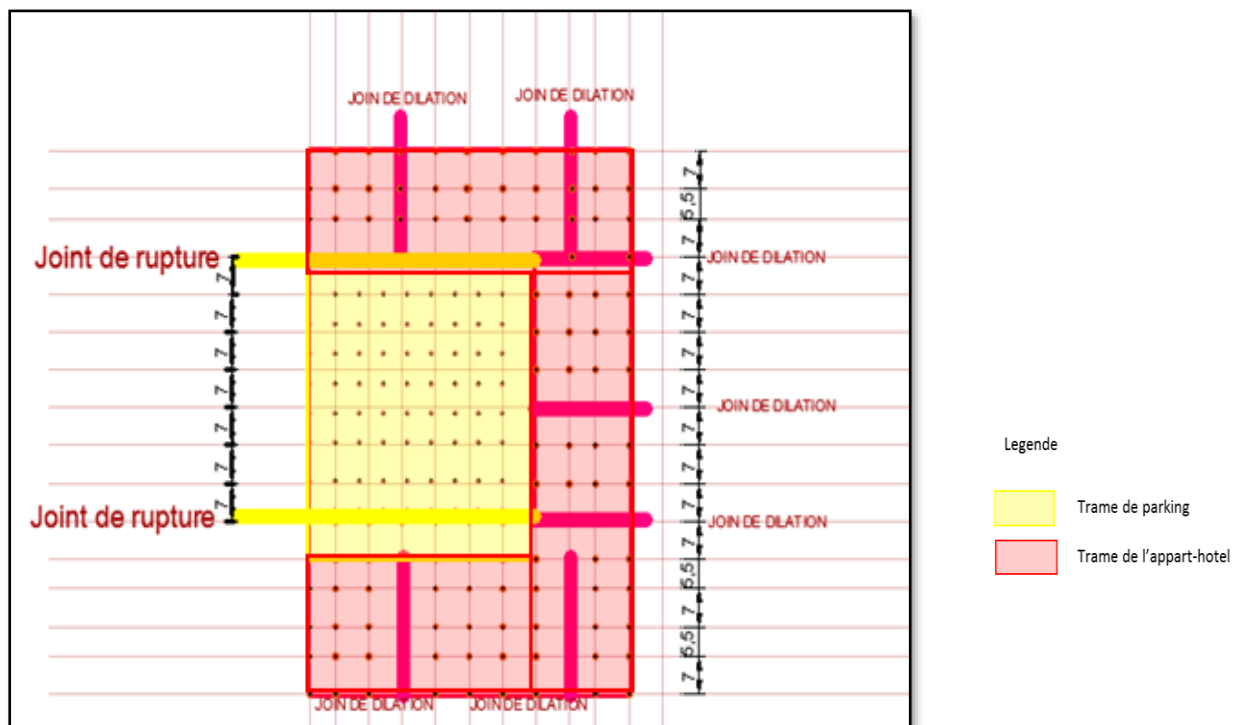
Photo de trame structurelle de l'appart-hôtel et le parking
